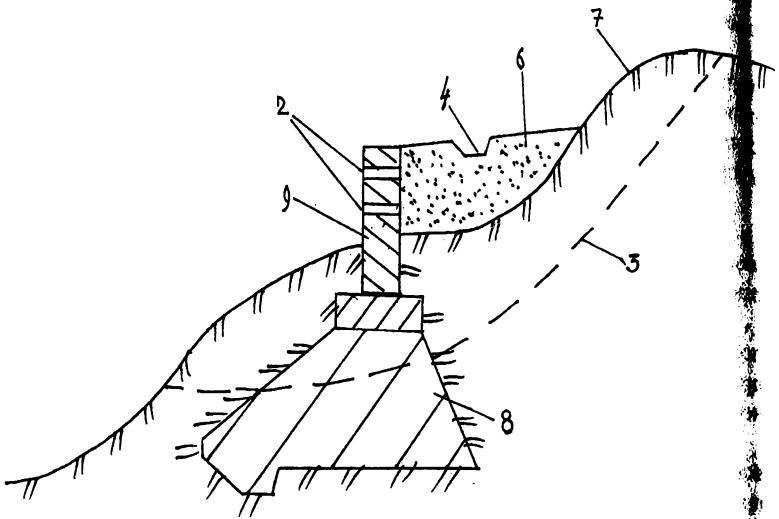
Схема крепления склона консольной подпорной стенкой на контрфорсах:
